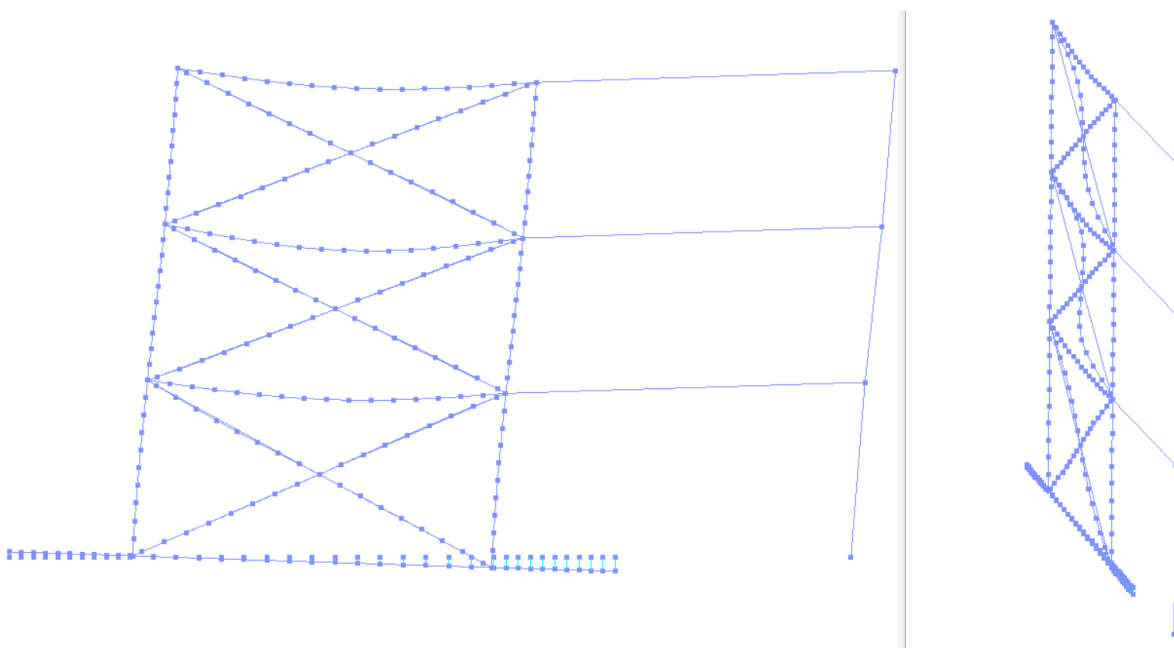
Positions déformées de la structure dans le plan et hors du plan (au bercement maximal)
